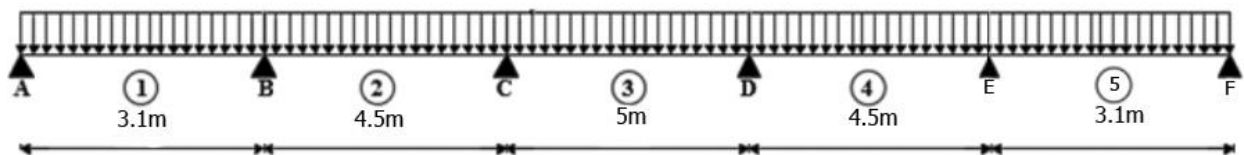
Schéma du 1^{ère} type de poutrelle
